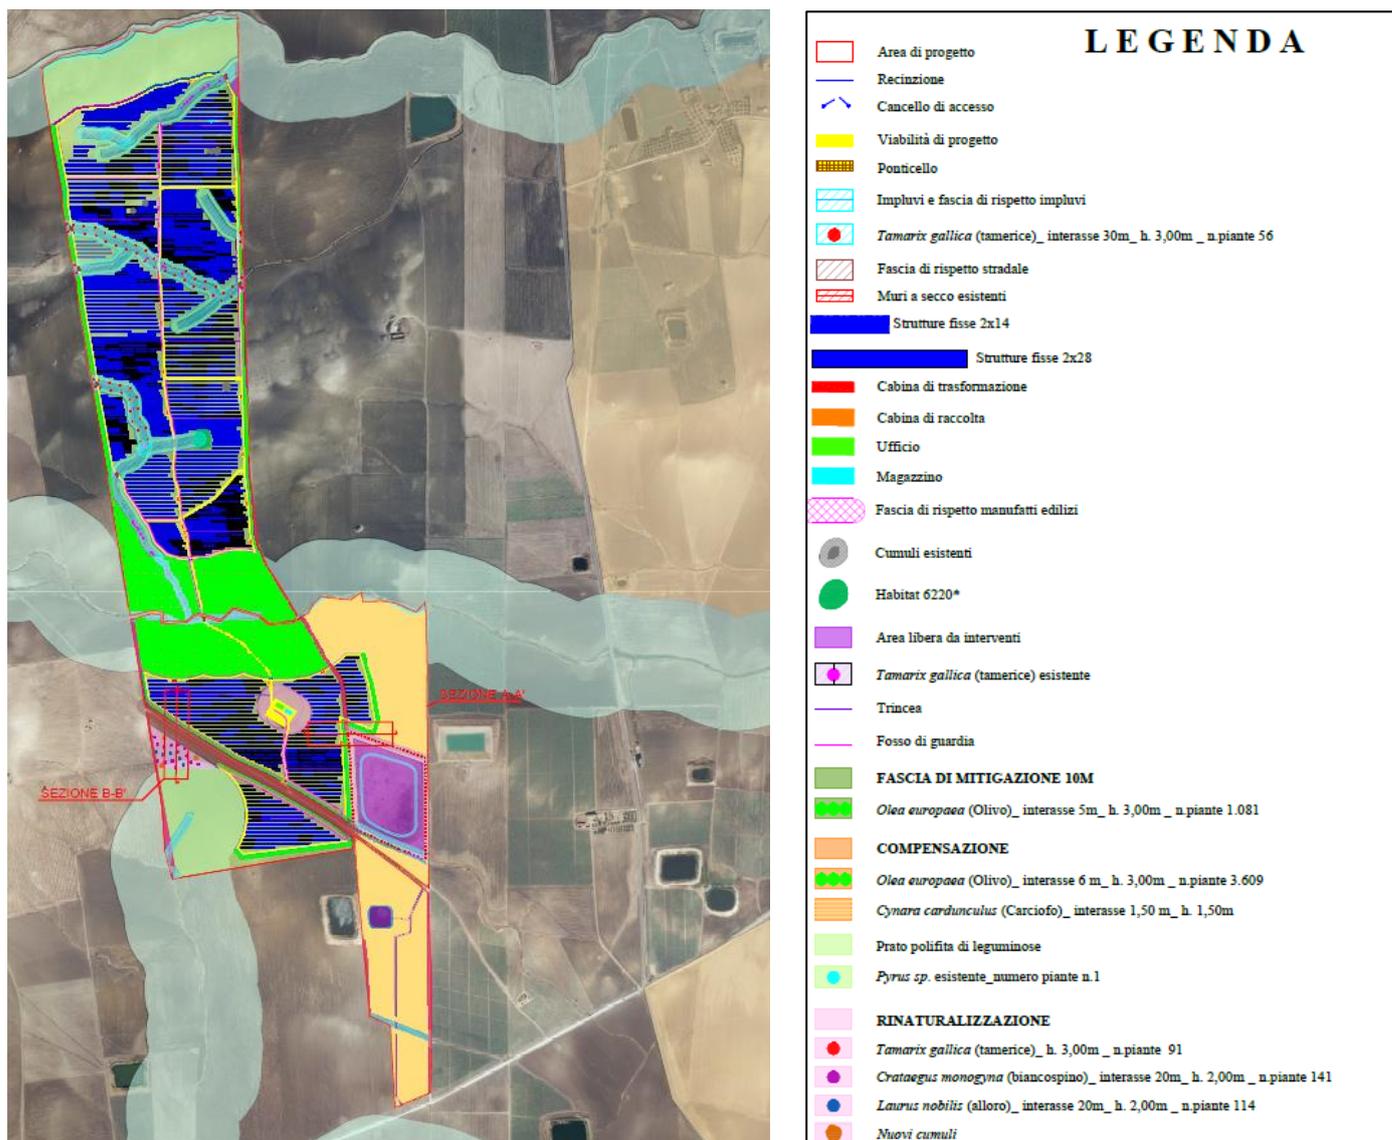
planimetria d’impianto con evidenza delle opere di mitigazione e compensazione.
